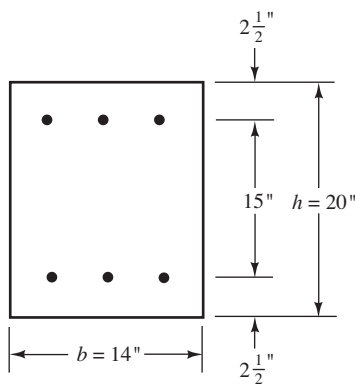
Sección transversal de la columna del Ejemplo 10.3.
